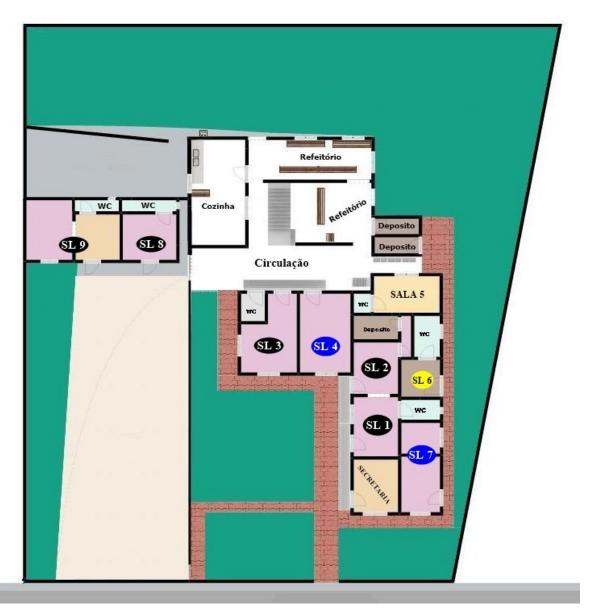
Planta baixa piso térreo CMEI Profa Julieta Pereira Muller.
